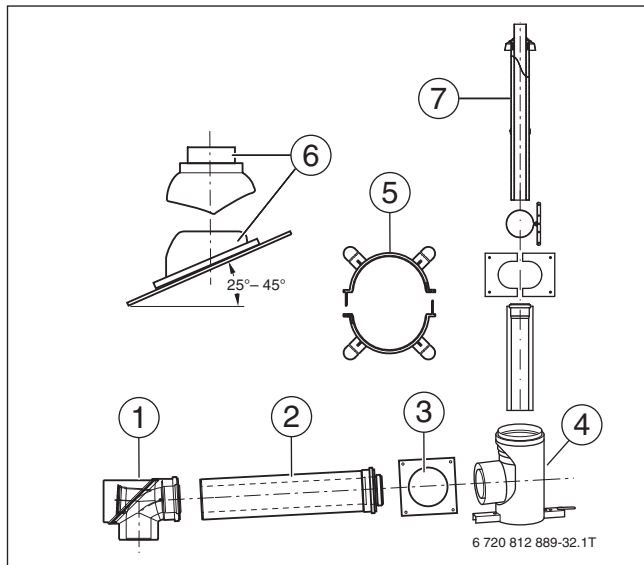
Bauteile Grundbausatz DO-S in DN 110/160
